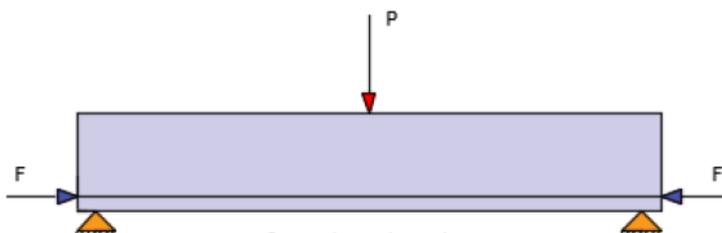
Sección de concreto ante la acción de las cargas (P). Aguilar, J, 2015. Análisis y diseño de un edificio de 8 niveles empleando diferentes sistemas de piso: losas de concreto reforzado perimetralmente apoyadas y losas planas de concreto postensado. pág. 19.
